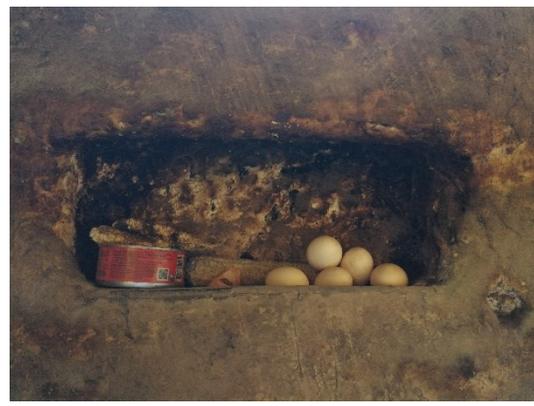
Nicho excavado en el muro de bahareque, caso 17.
